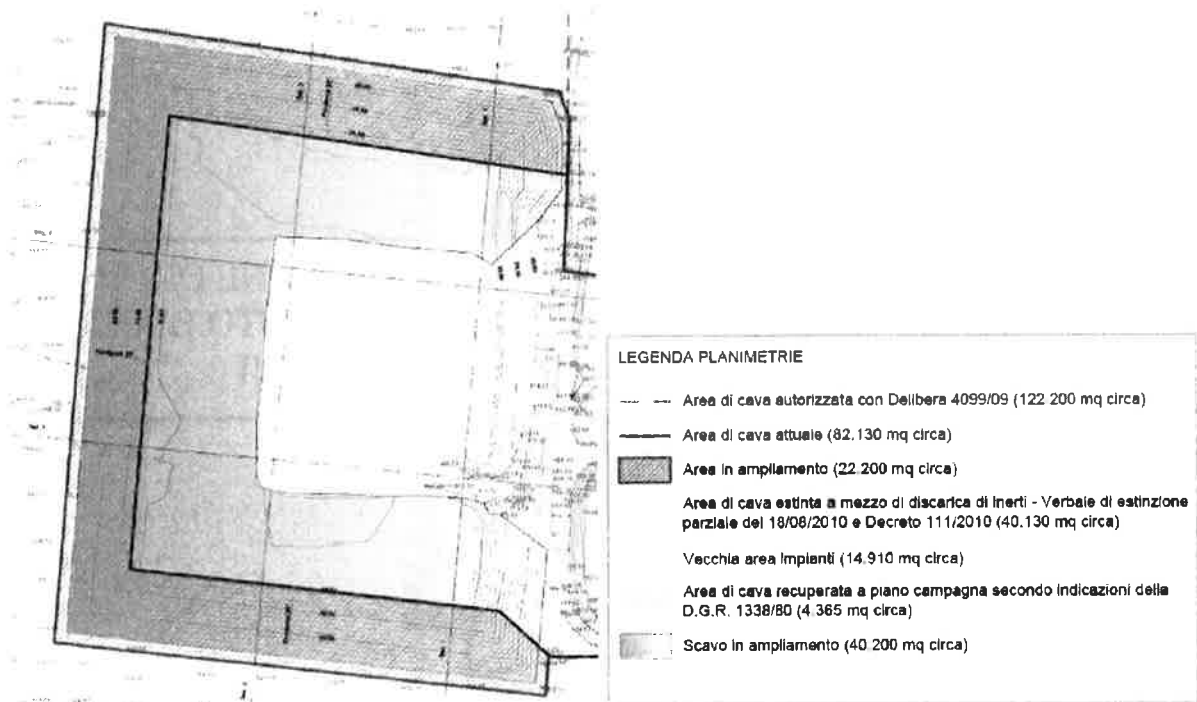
/II: Estratto planimetria di progetto di coltivazione
